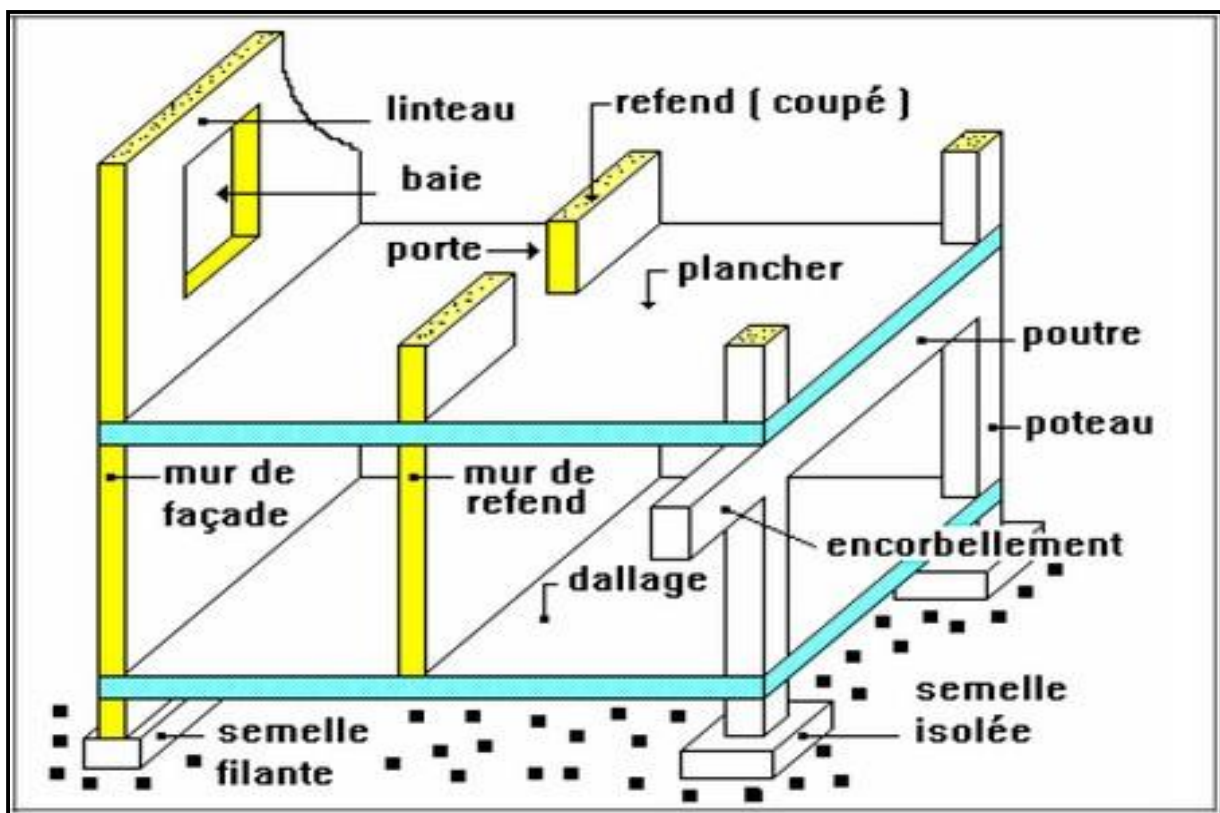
schéma explicatif des différents éléments structurels du système poteau poutre,
